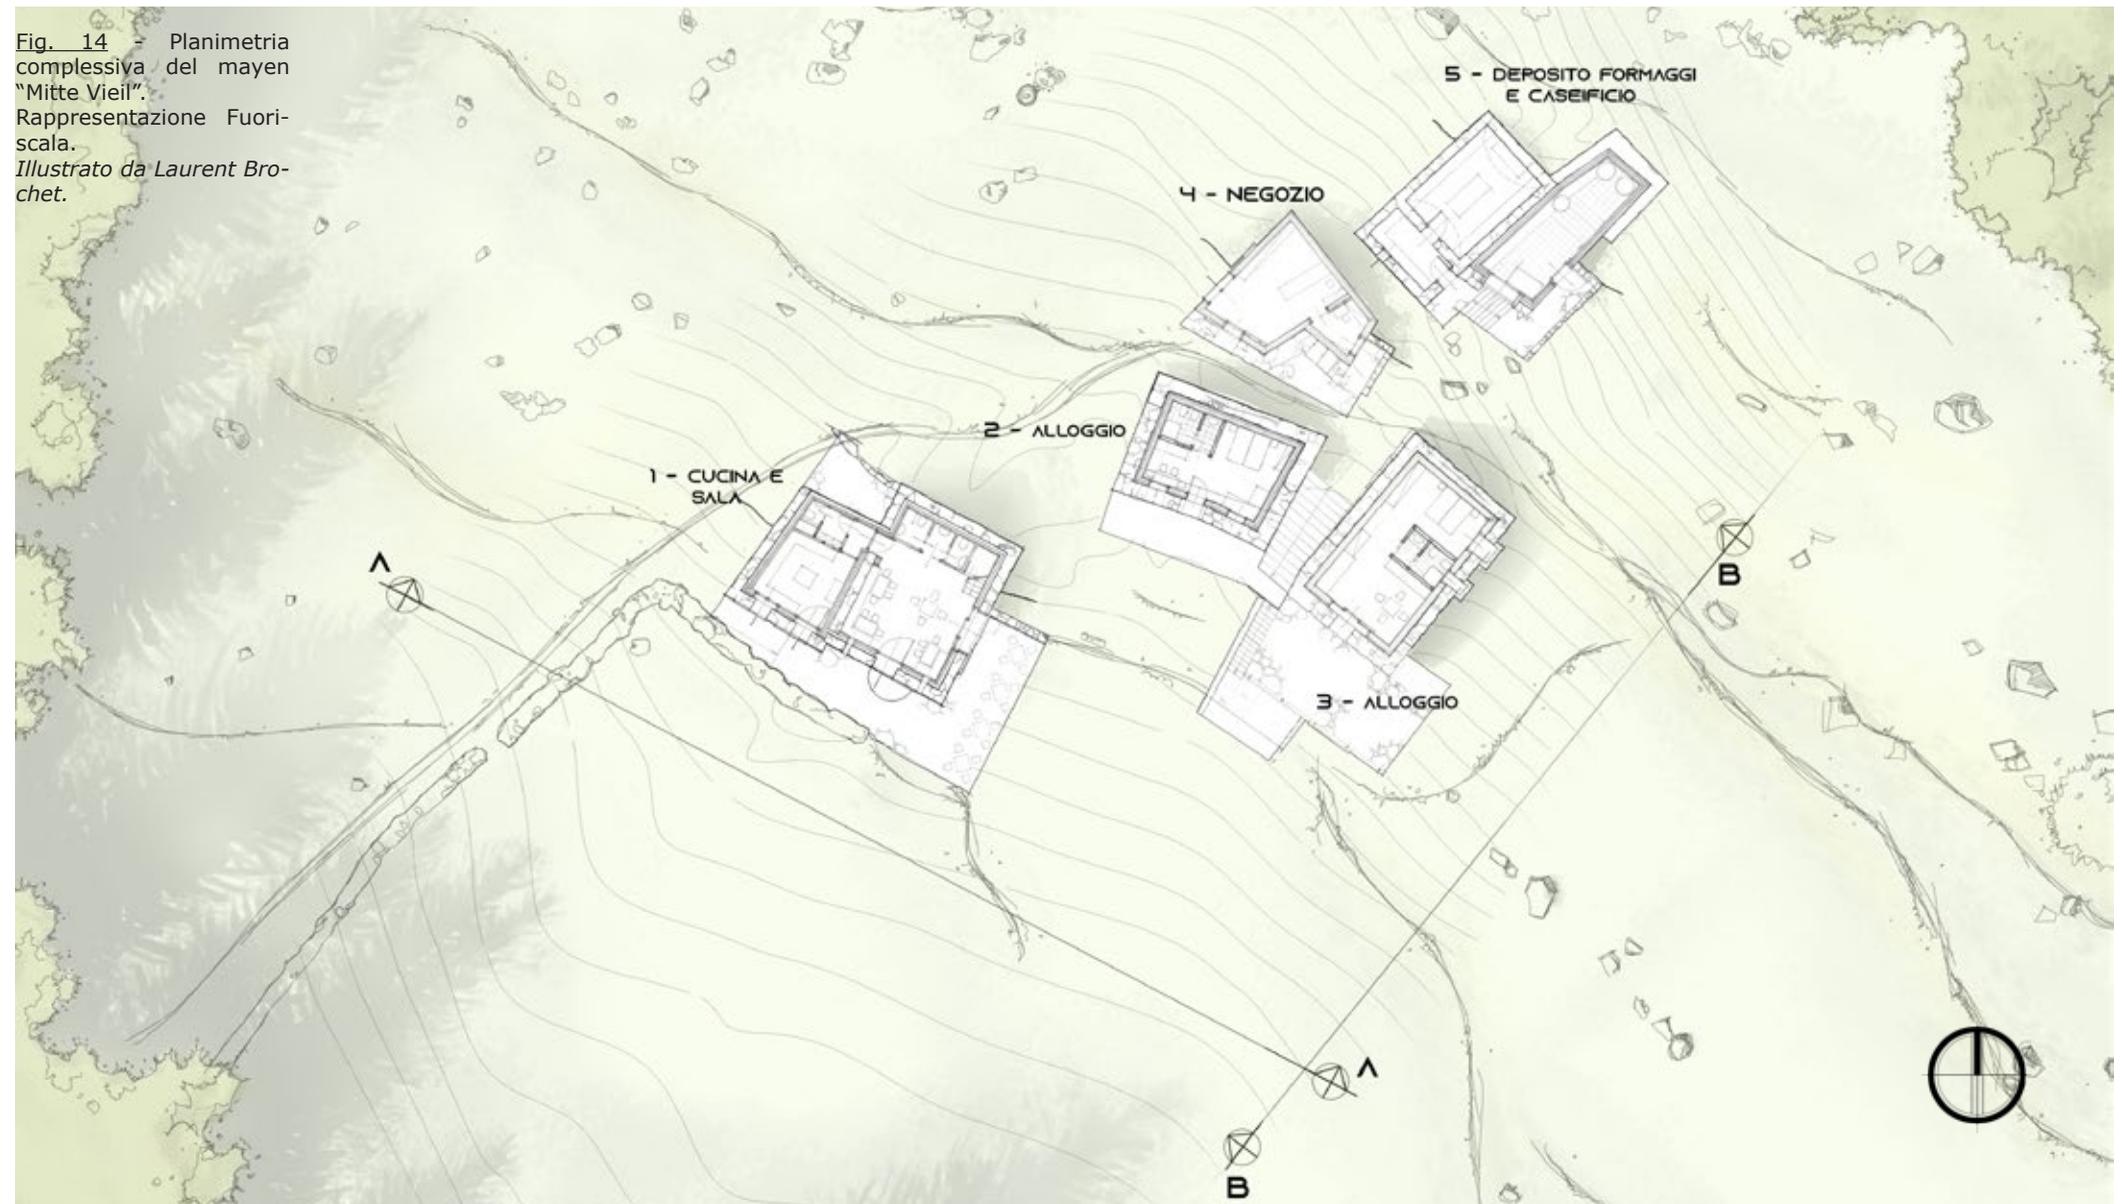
Planimetria complessiva del mayen "Mitte Vieil". Rappresentazione Fuori-scala. Illustrato da Laurent Brochet.
